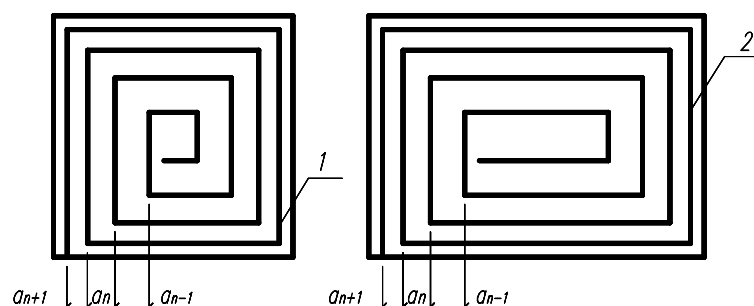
Принципиальная схема конструирования усовершенствованных спиральных сеток для армирования элементов квадратного (1) и прямоугольного (2) поперечных сечений
